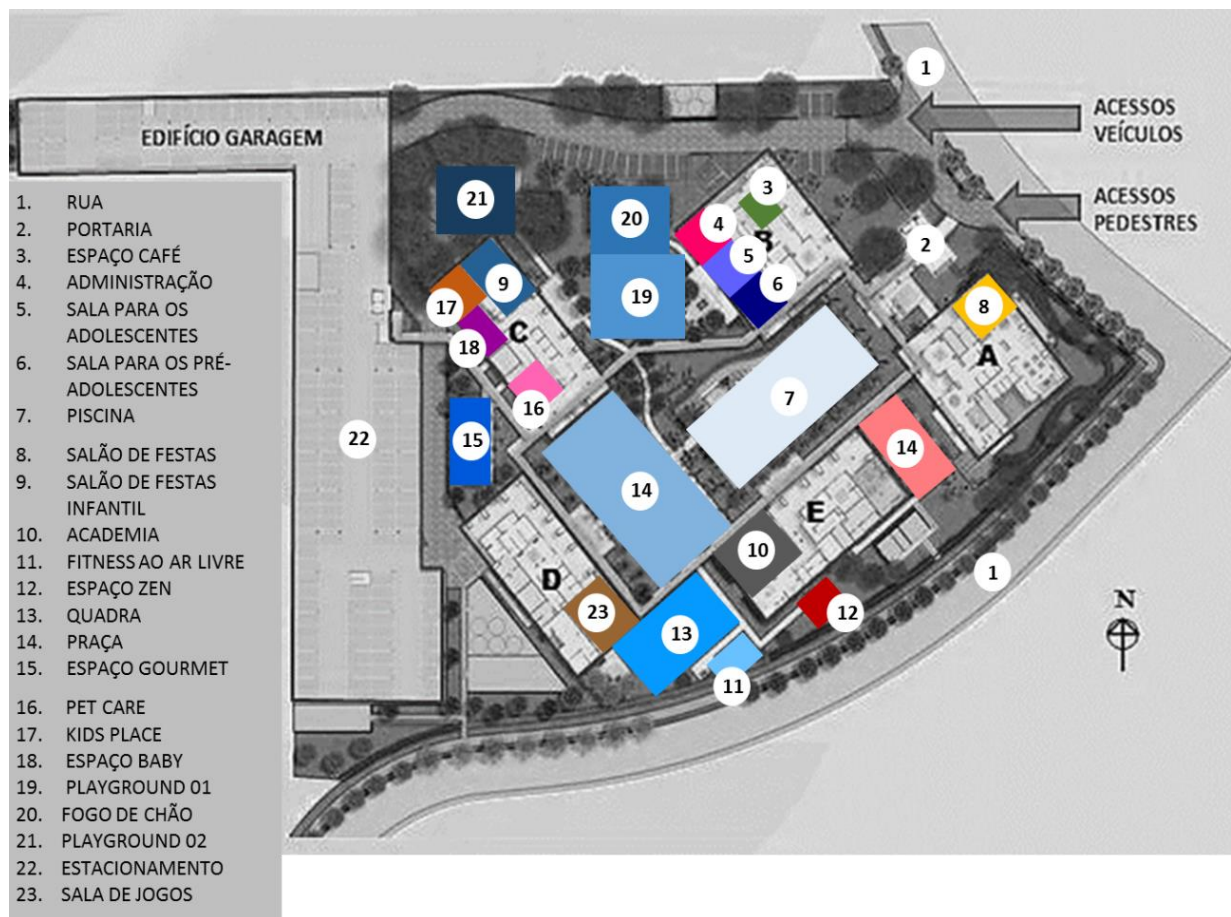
Planta baixa de conectividade da área de lazer do edifício 02. Fonte: site da construtora, modificada pela autora.
